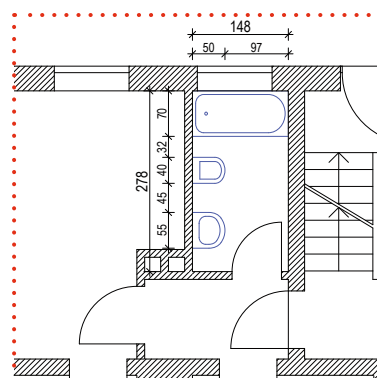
Detail Bad Ingolstadt, Schubertstraße 34–38
